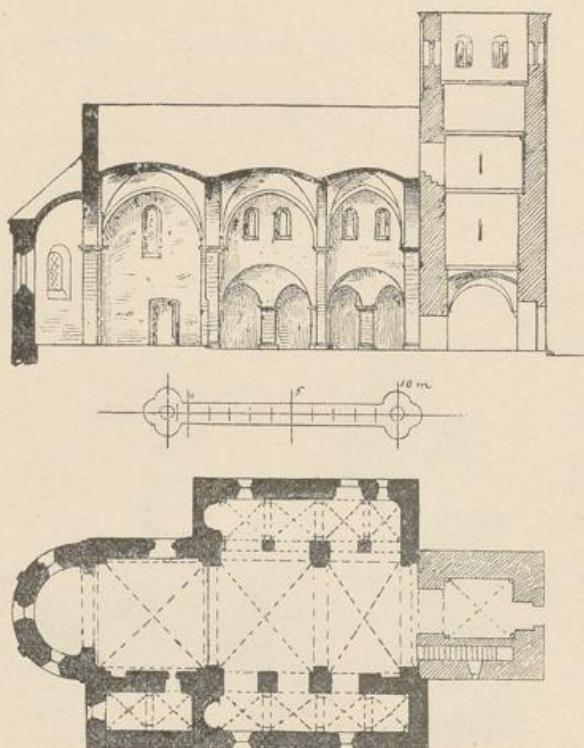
Düssel. Querschnitt und Grundriss der katholischen Pfarrkirche vor der Restauration.
